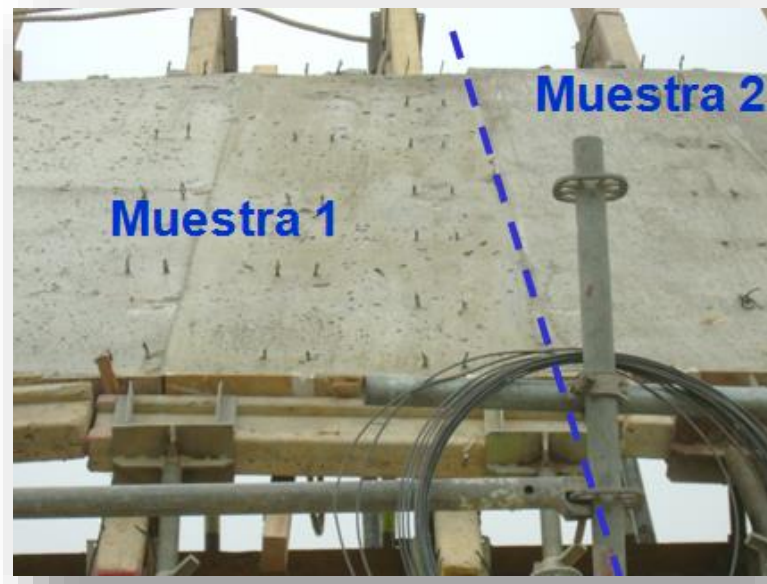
Muestras de Concreto (Vibrado/Sin Vibrado)
